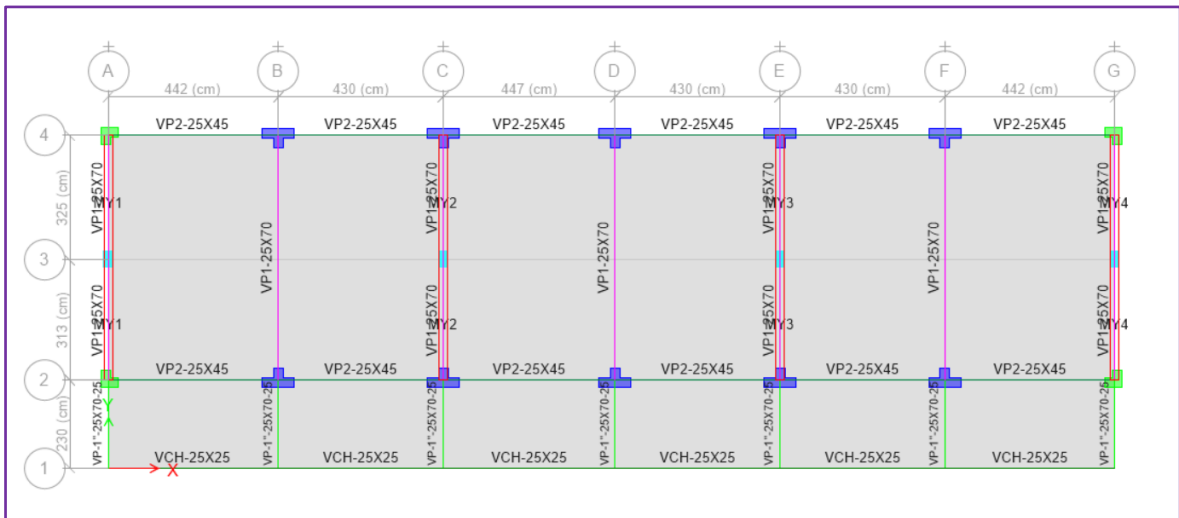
distribución de las vigas en el primer nivel del pabellón A
